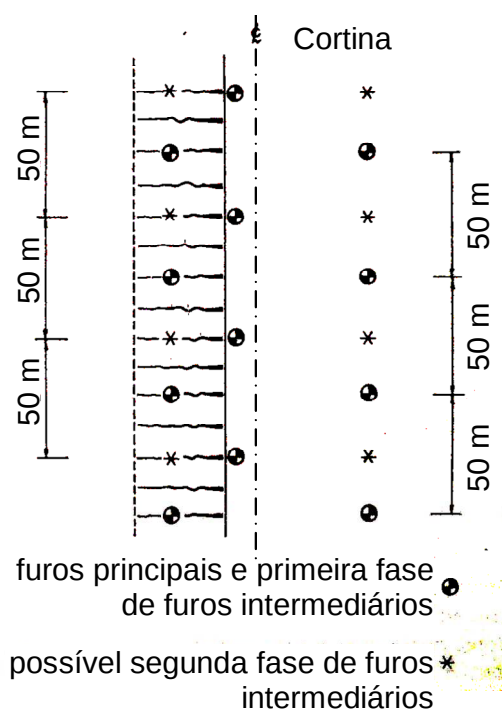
Esquema da locação em planta para a locação das investigações – adaptado de Clayton e Milititsky (1986)
